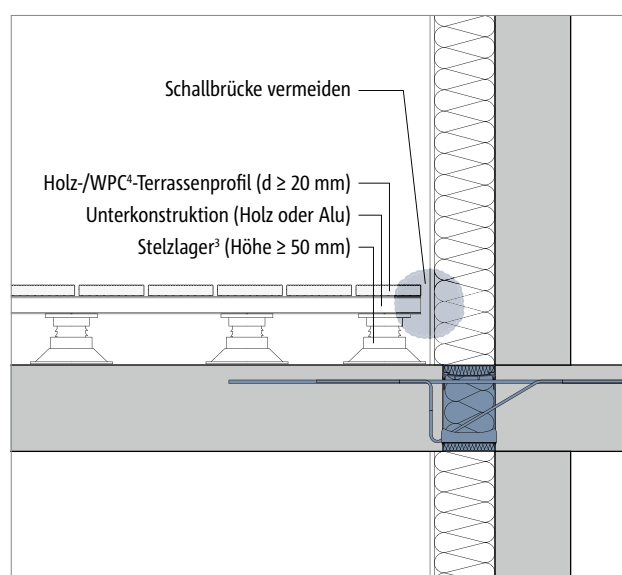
Balkonbelag mit Holz-/WPC-Terrassenprofilen, Unterkonstruktion (Holz oder Alu) und Stelzlager
